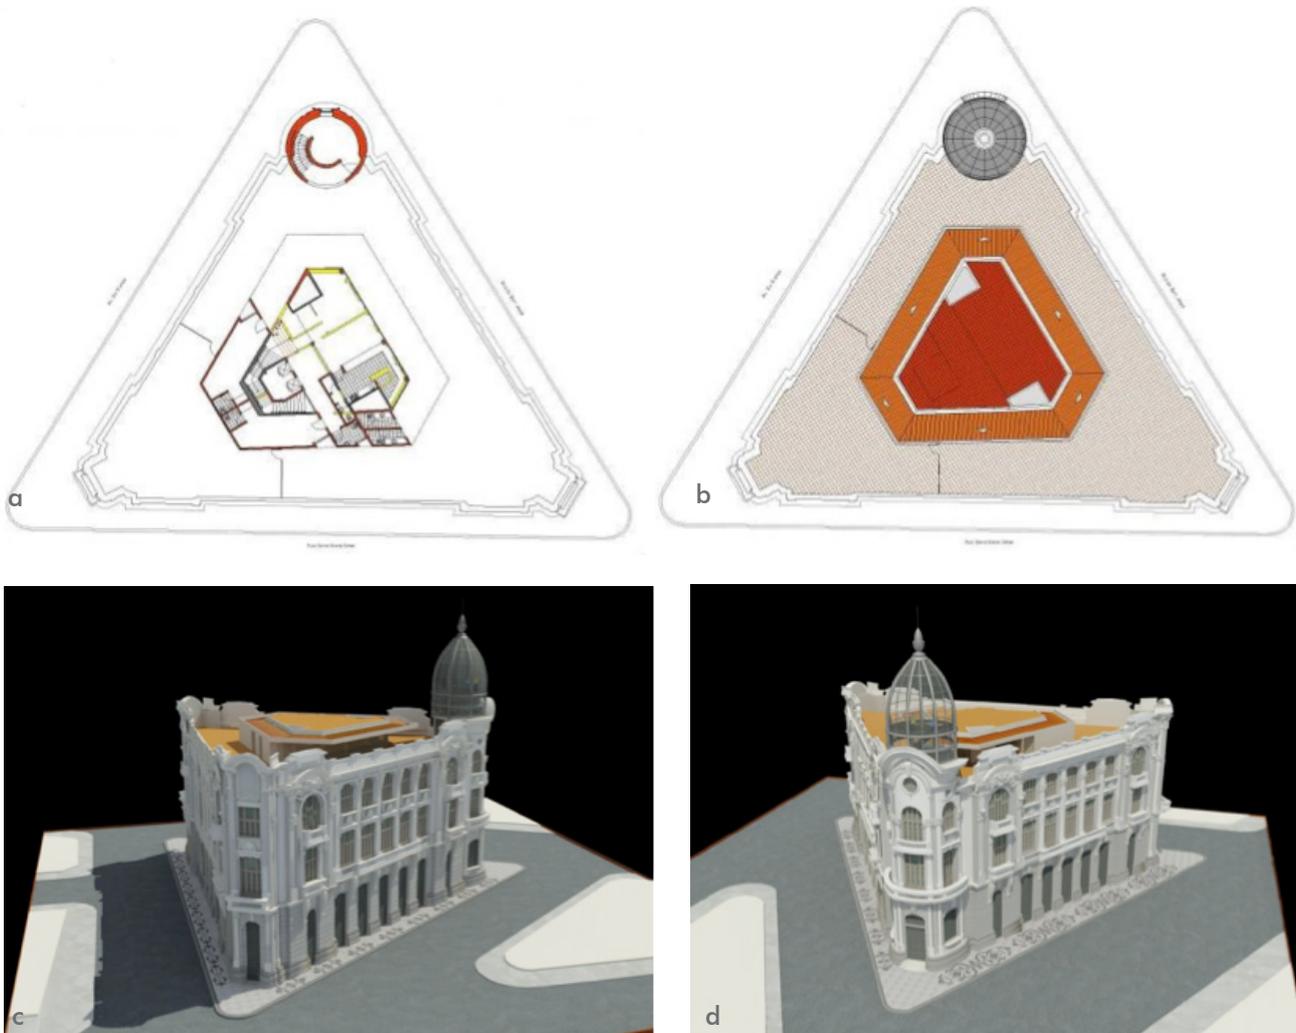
| Proposta para a cobertura. 26a: Planta-baixa; 26b: Coberta; 26c: Vista da Rua do Bom Jesus; 26d: Vista da Avenida Rio Branco
